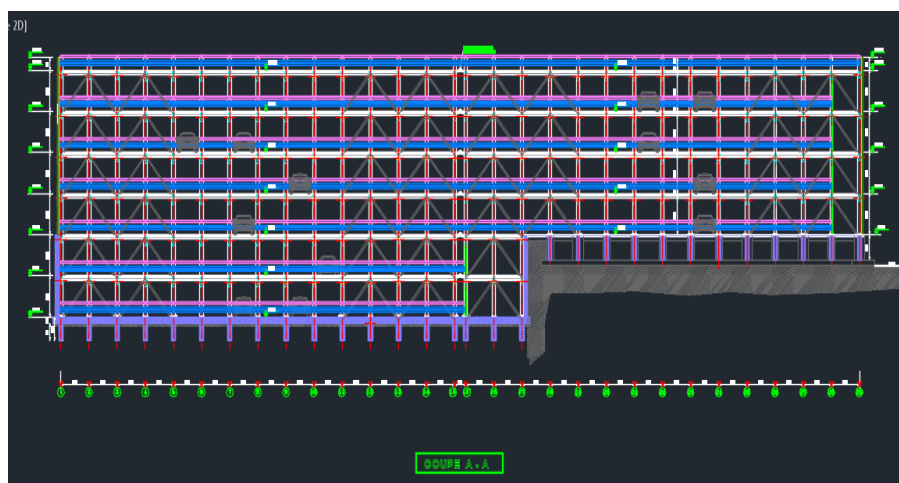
Coupe verticale de la construction (Autocad, bureau d'étude).
